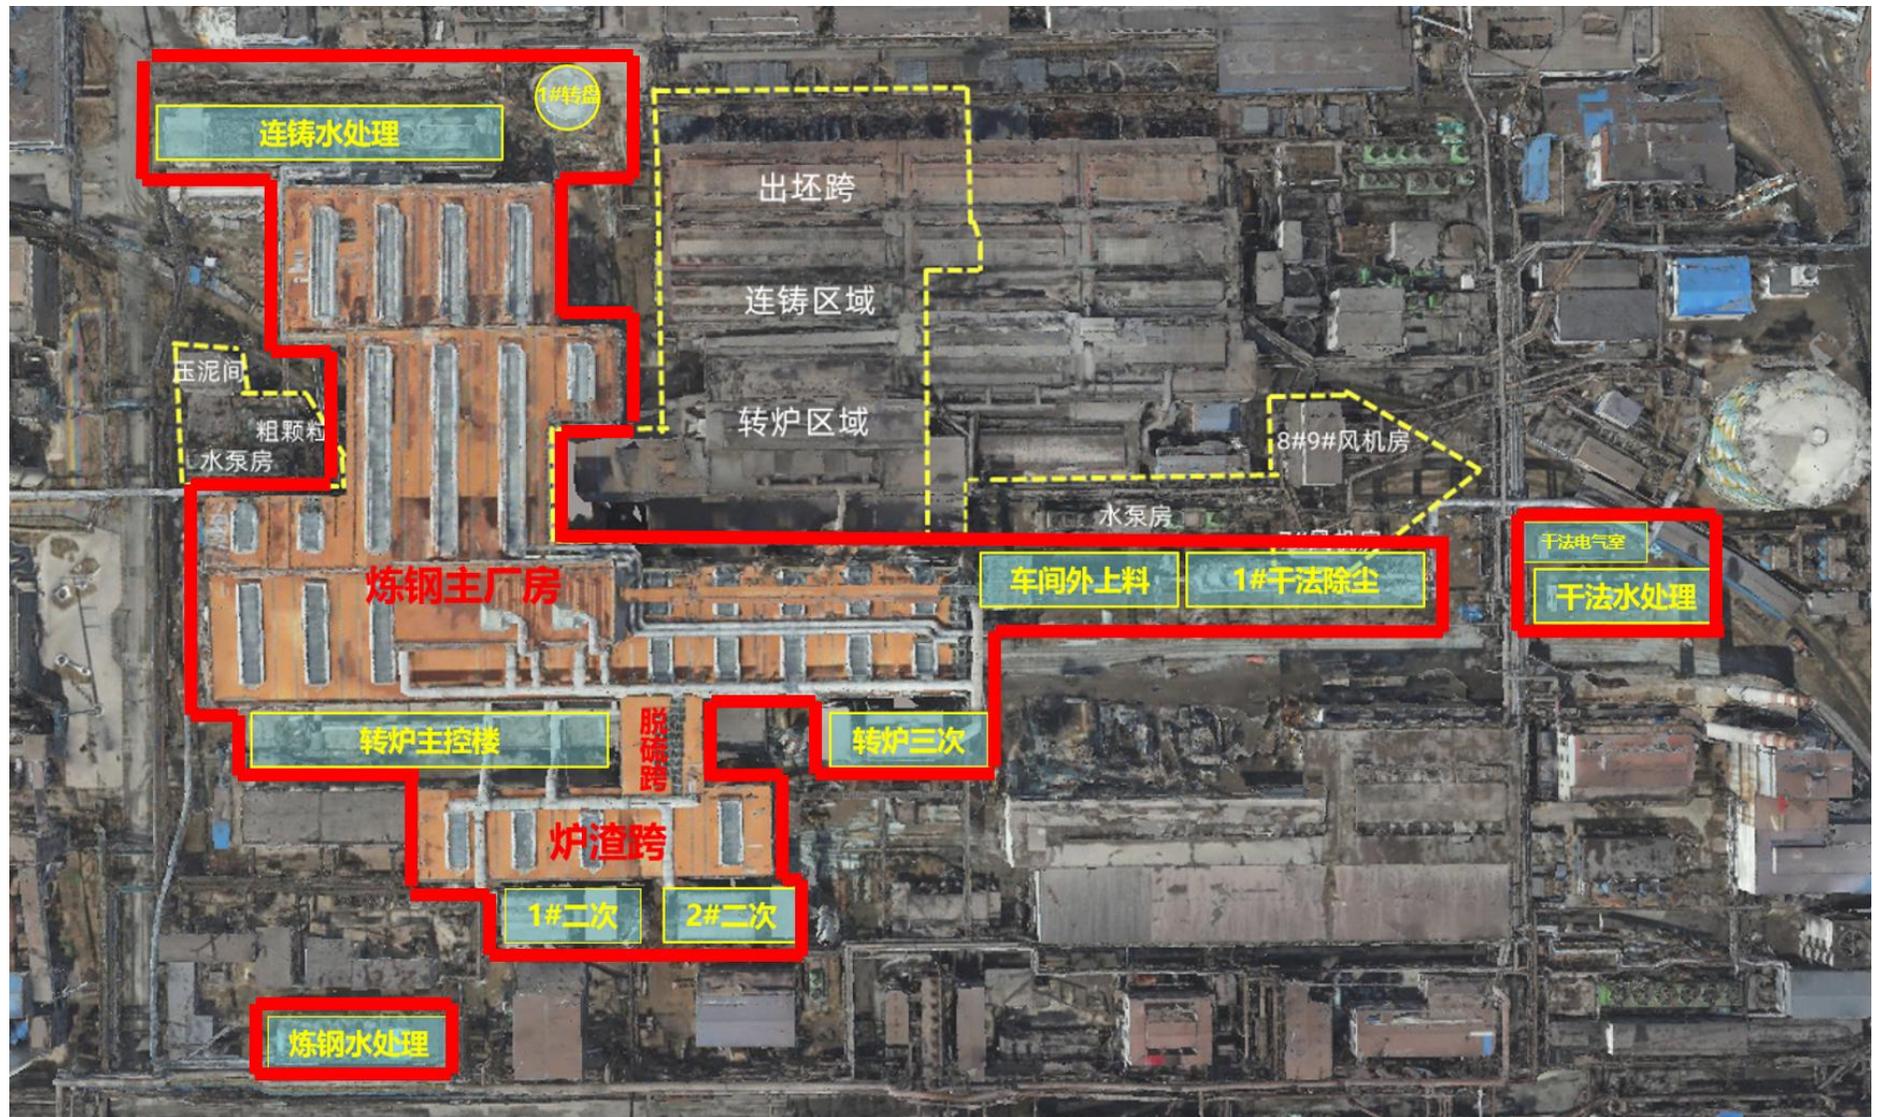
抚顺新钢铁环保改造一期工程平面布置示意图
